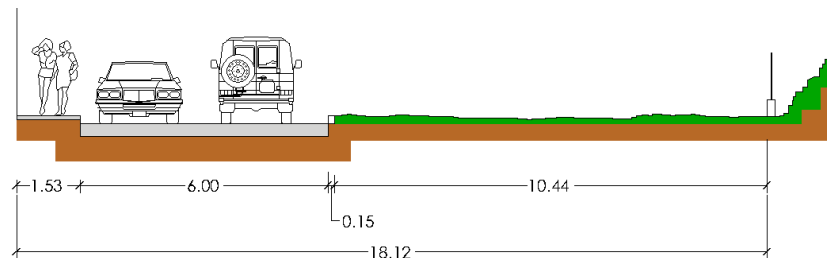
Sección transversal Calle Sto. Domingo de los Colorados
